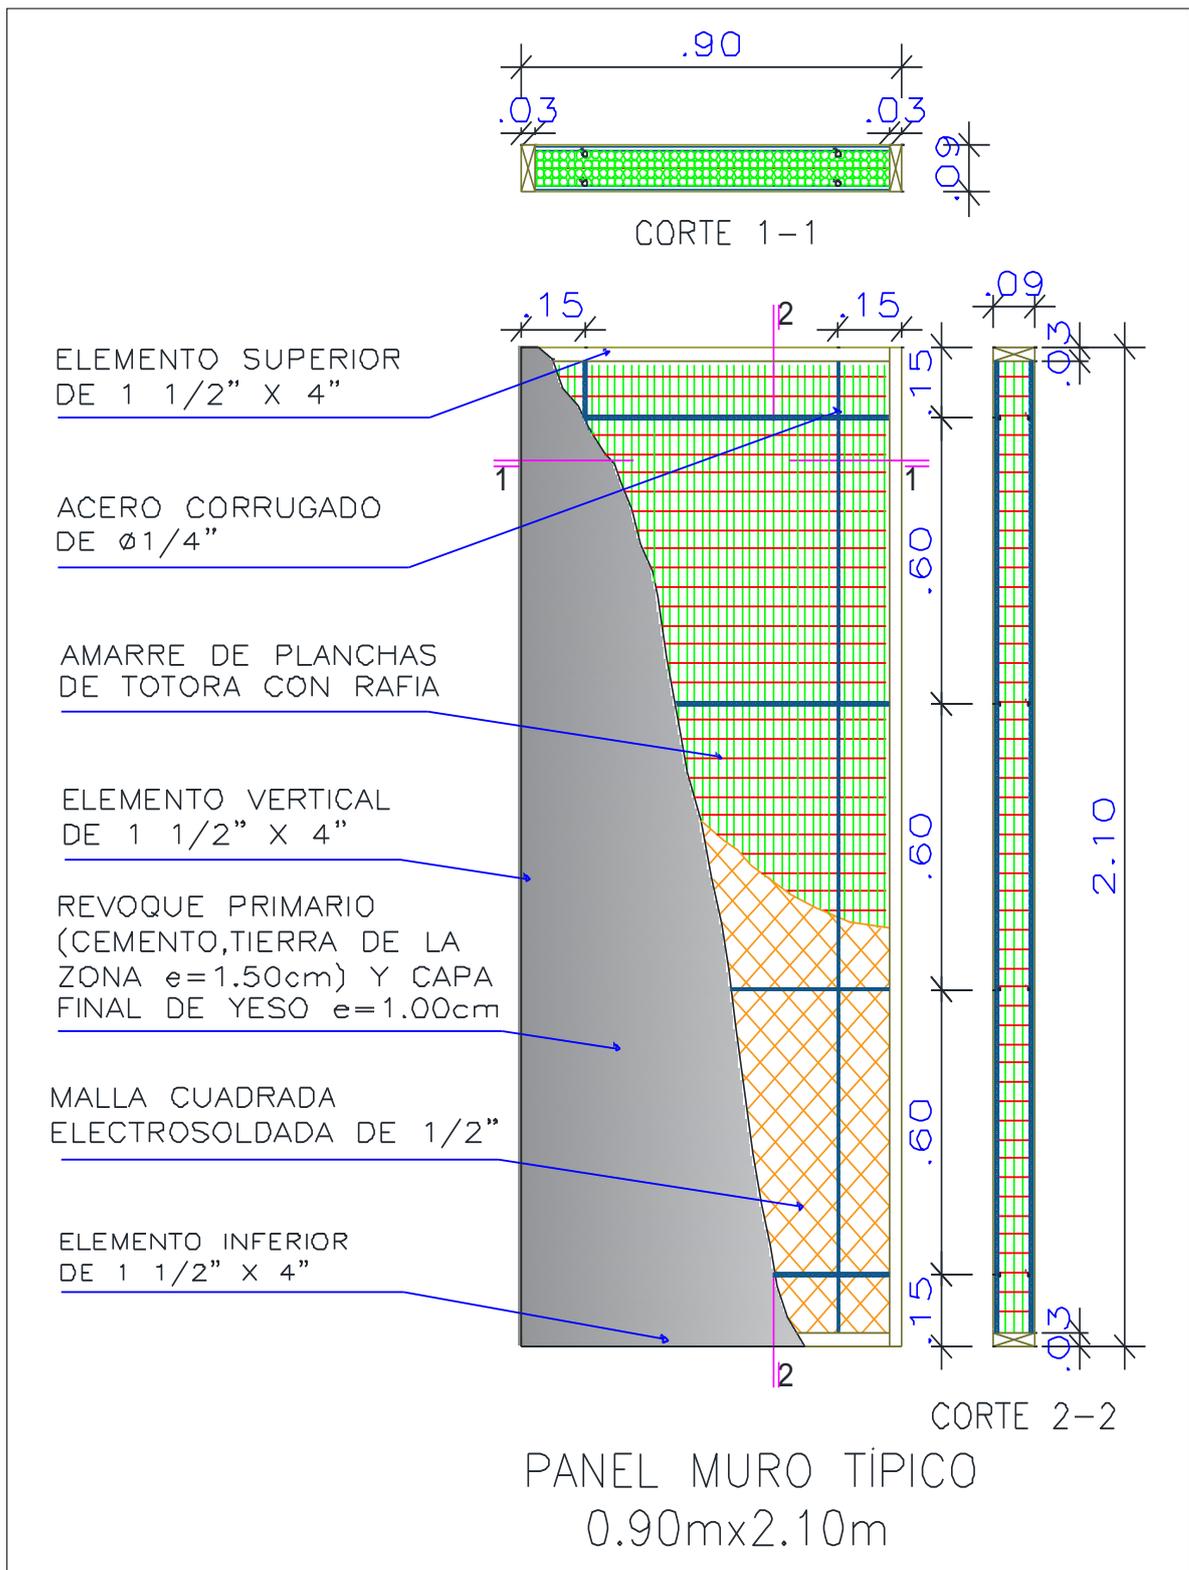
Panel muro típico 0.90 m x 2.10 m del sistema constructivo propuesto
